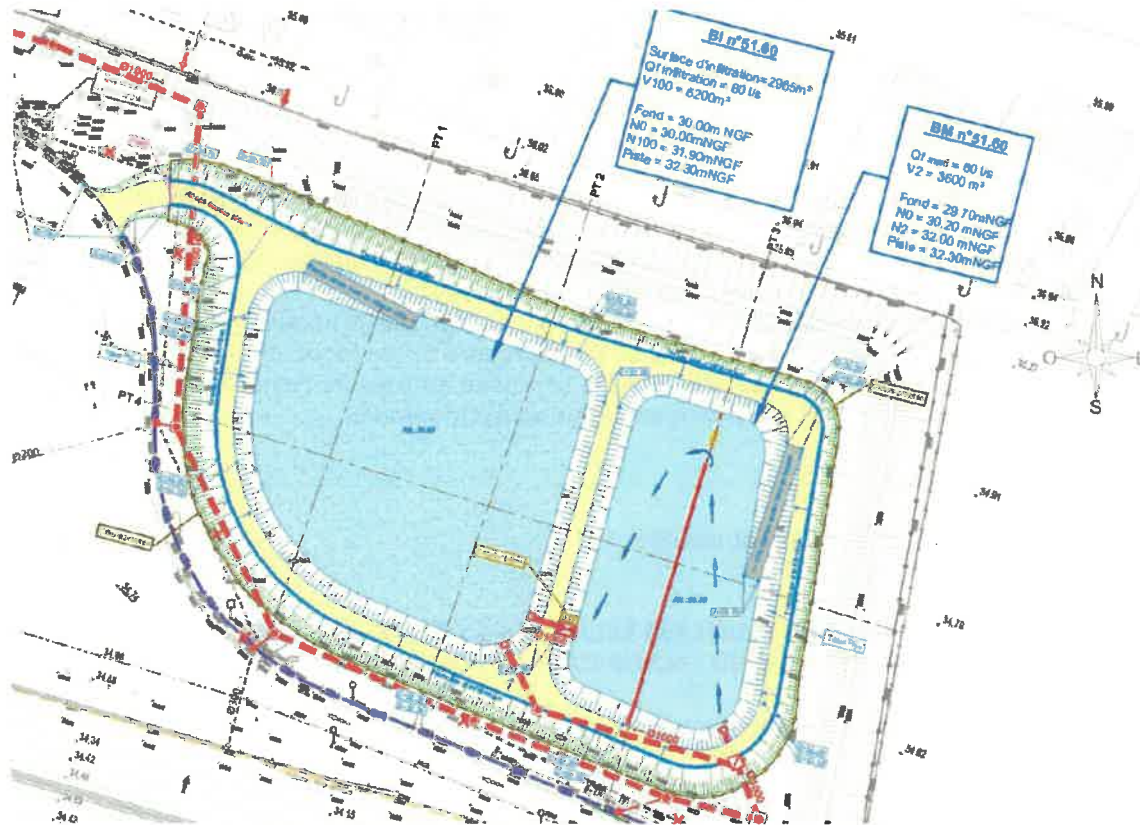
Plan de masse des bassins de gestion des eaux pluviales
